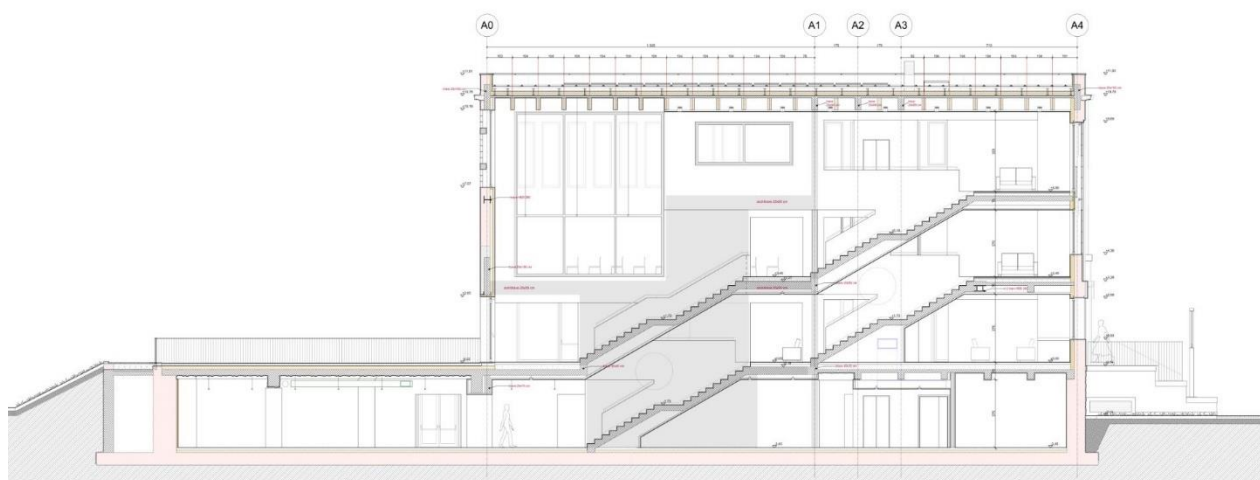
Sezione longitudinale in corrispondenza delle rampe di scale a nord
